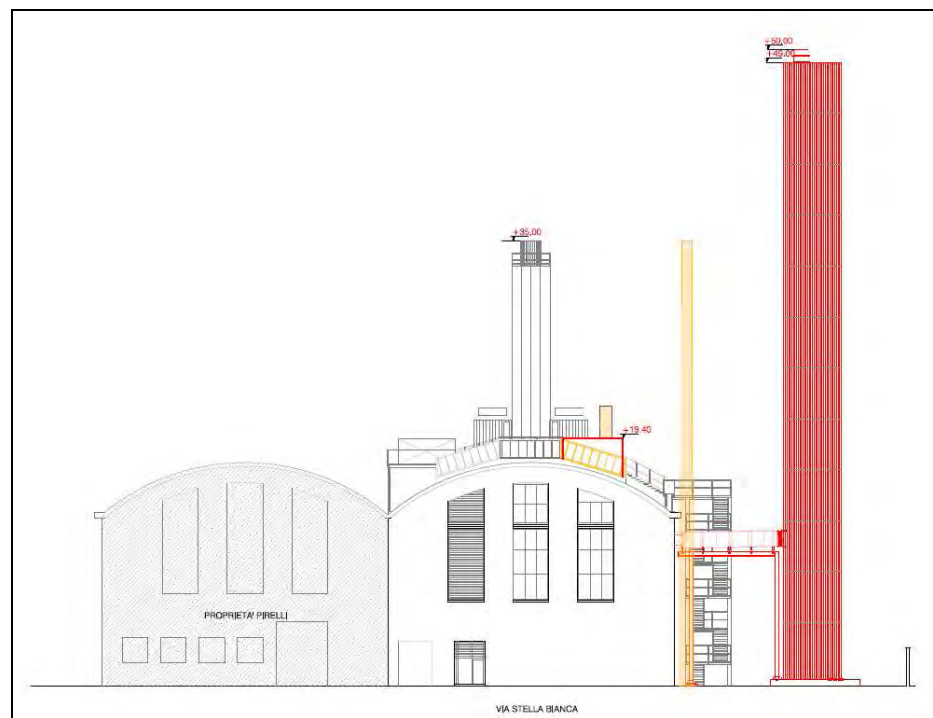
Estratto tav 03 – Progetto definitivo: prospetto sud (confronto da via Stella Bianca)
